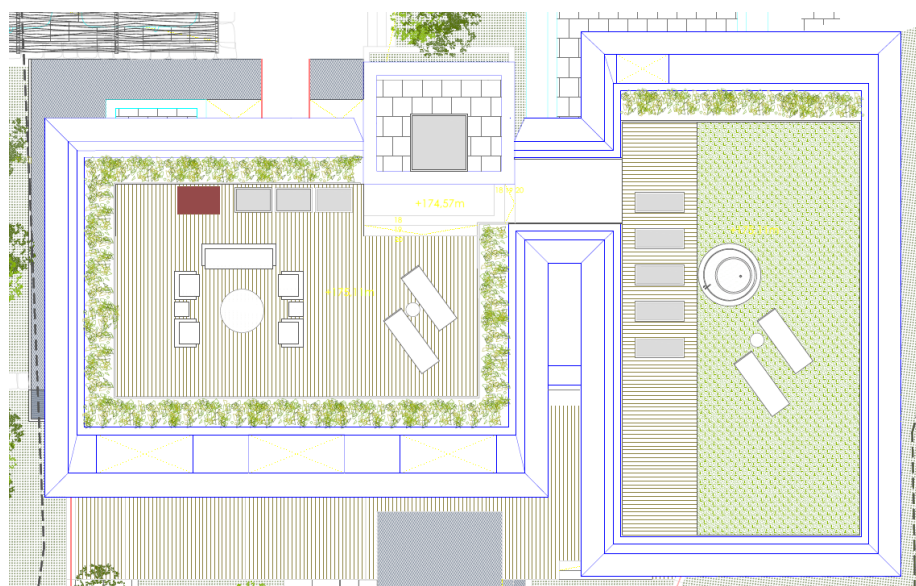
Planta cubierta del proyecto de ejemplo con la posición de las jardineras.
